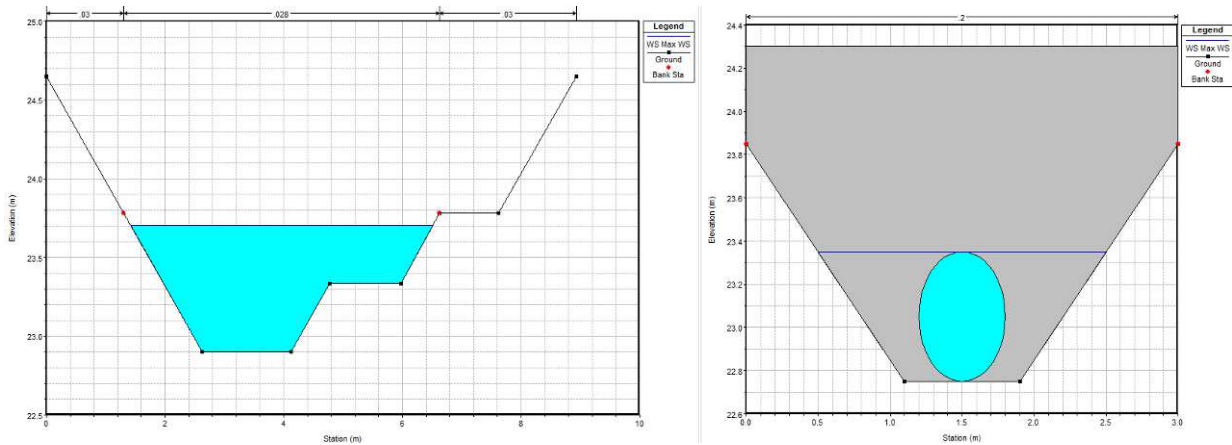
Cavata Orientale: sezione tipo di progetto nel tratto di monte e tratto in condotta con diametro 600 mm.
